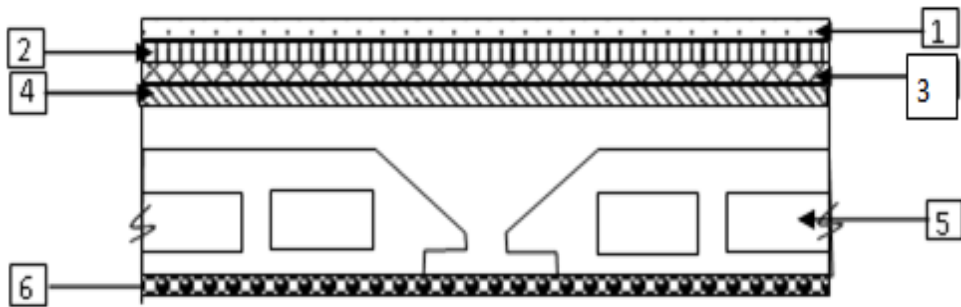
Coupe transversale d'un plancher terrasse inaccessible
